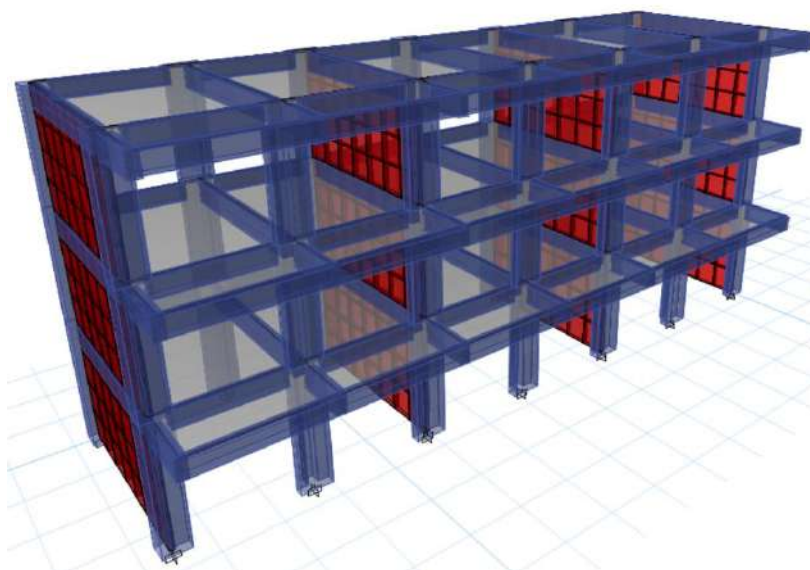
Modelo final del bloque B de la nueva propuesta de estructuración.
